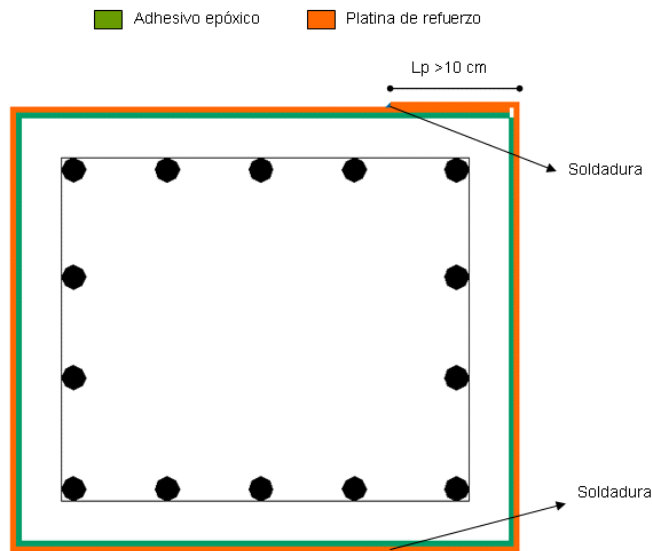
Esquema ilustrativo para el reforzamiento de columnas a flexo compresión con platinas metálicas
